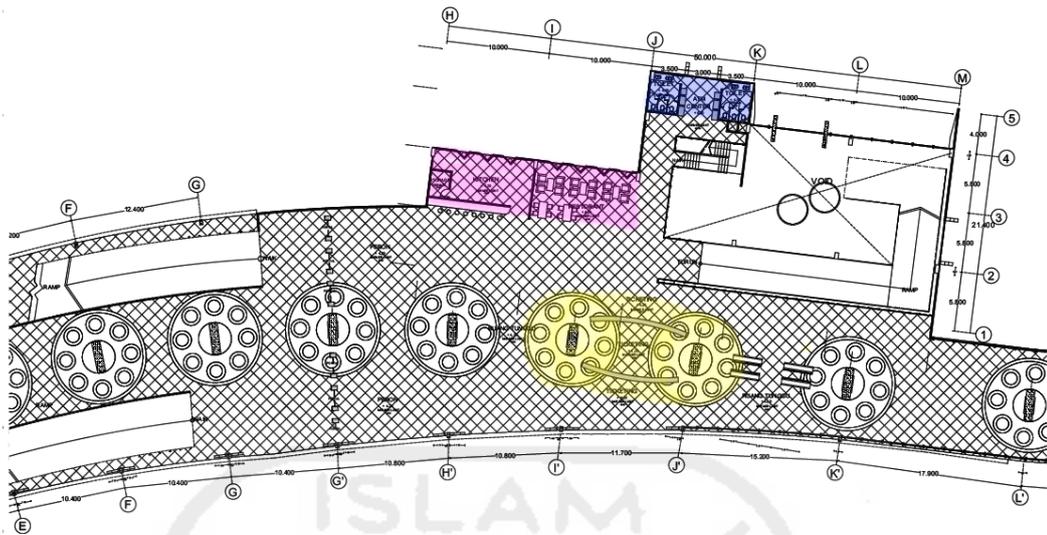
Tata Ruang Dalam, Denah LT1 Stasiun MRT
